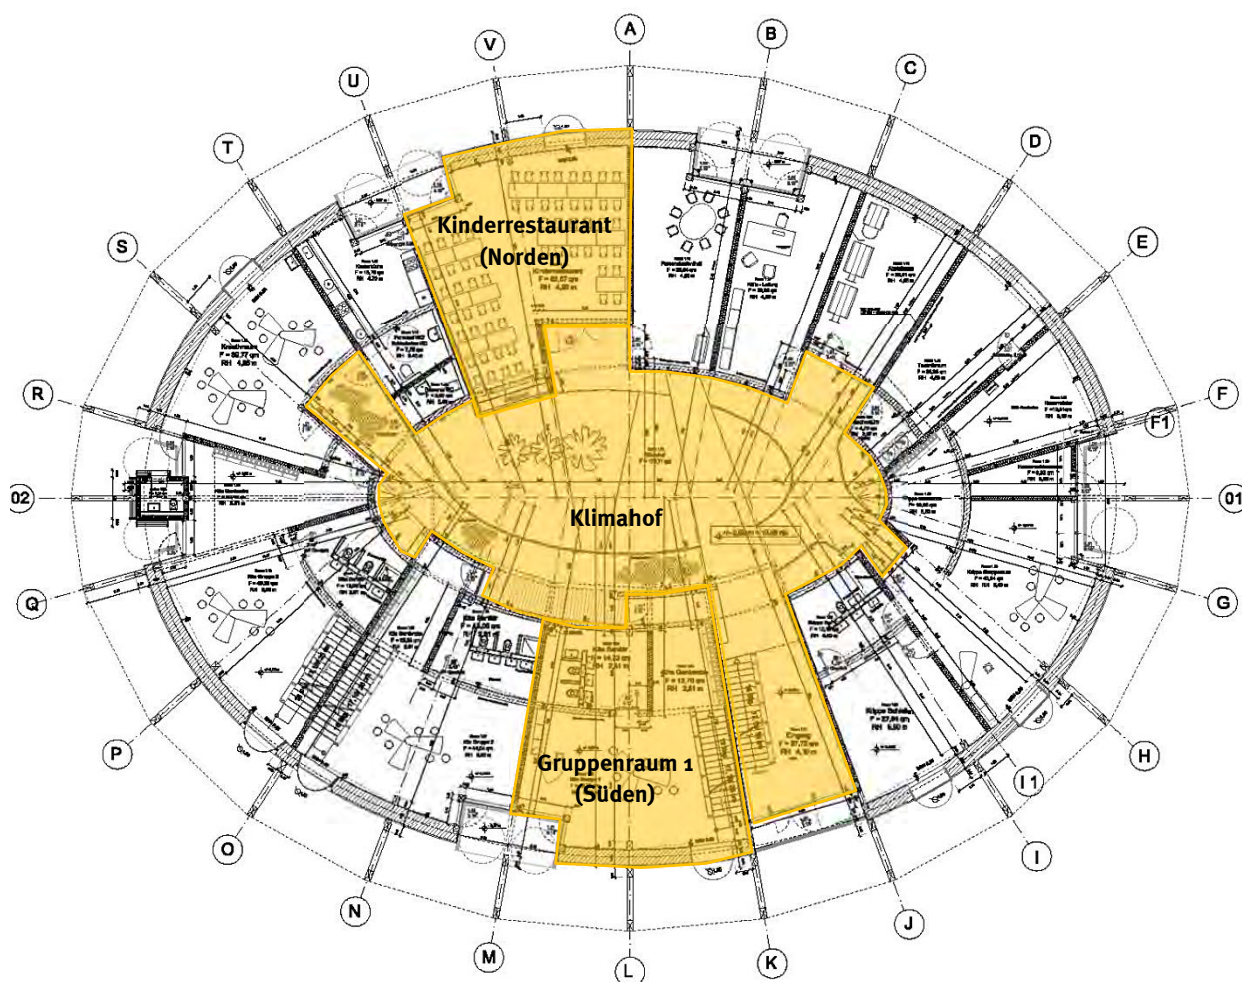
Grundriss Erdgeschoss mit ausgezeichneten exemplarischen Messräumen
